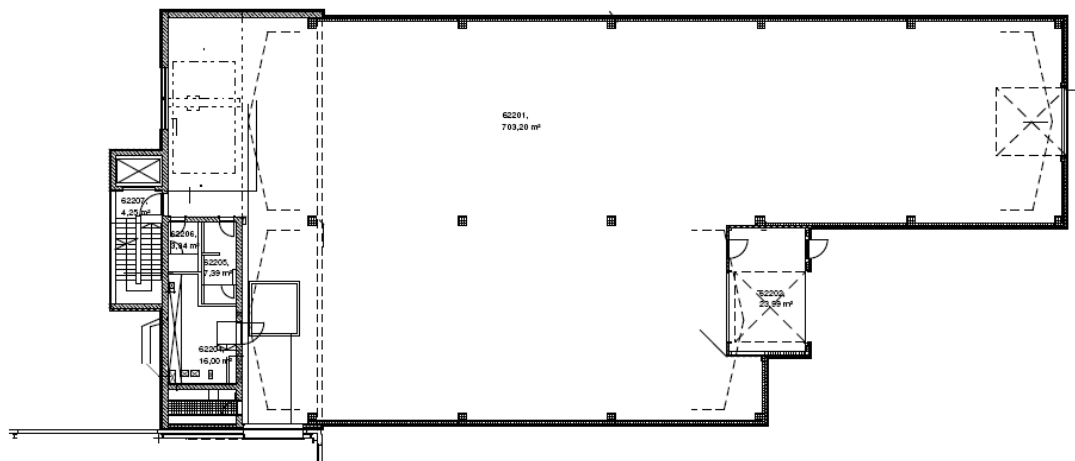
Grundriss B_62 Erdgeschoß
